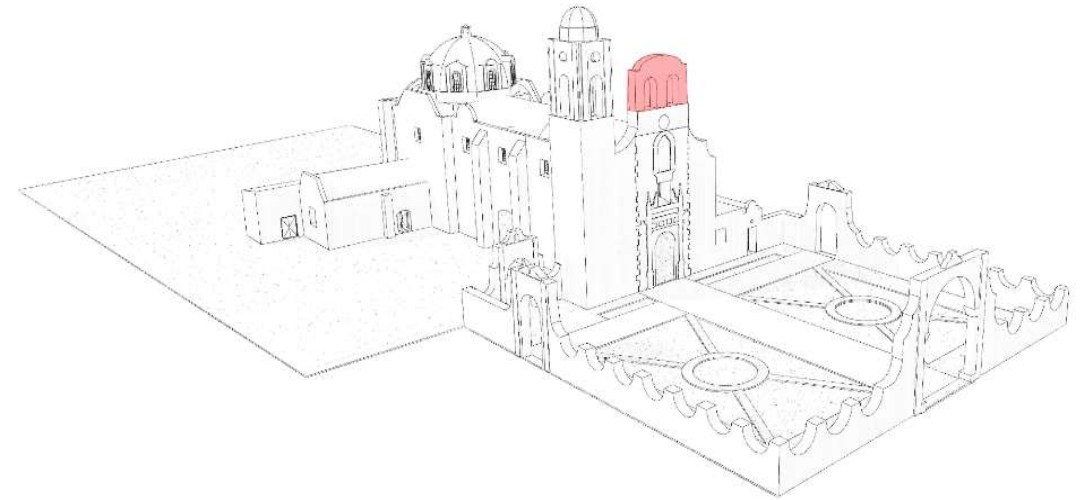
Sexta etapa constructiva, estado actual de la parroquia de San Martín Obispo. Autor: SLF
